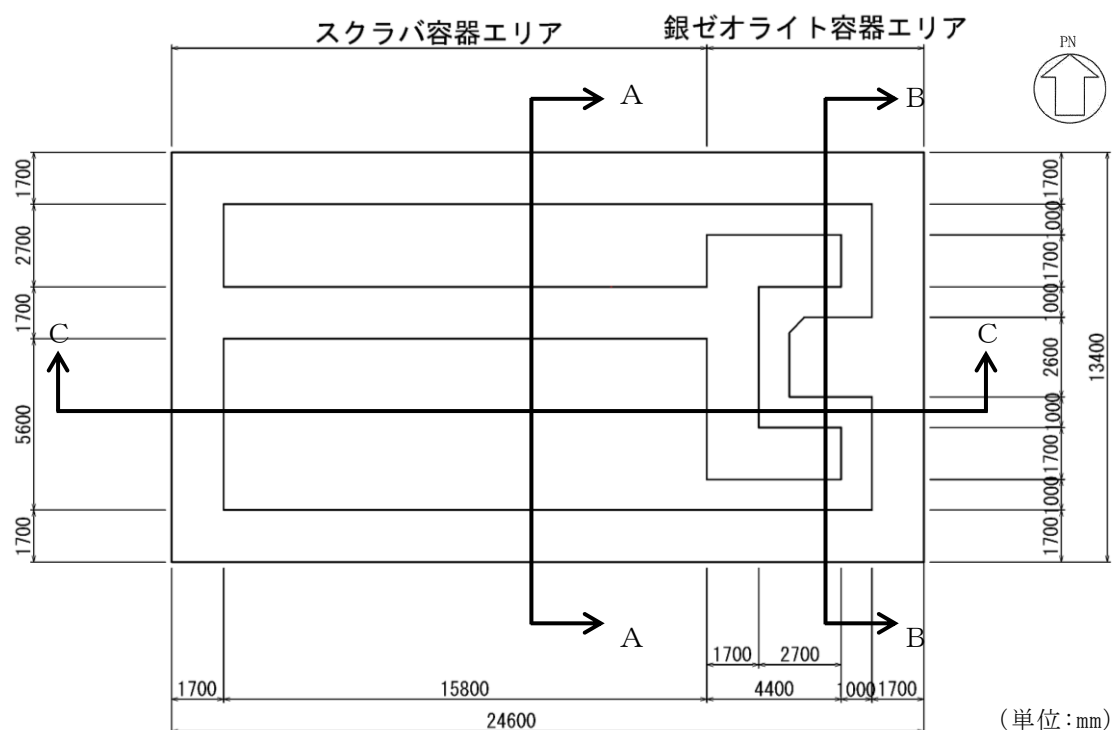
第1ベントフィルタ格納槽 平面図 (EL 3.00m)
